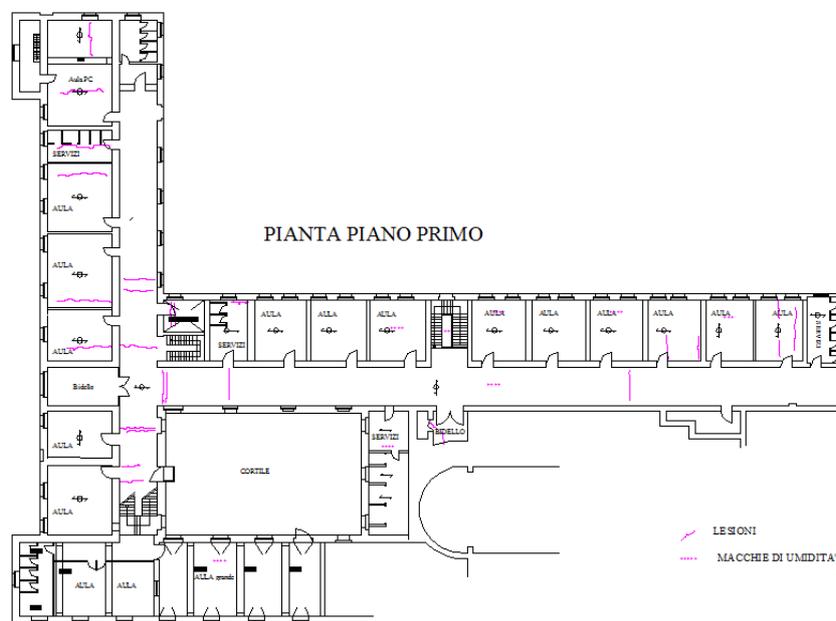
Rilievo quadro fessurativo primo piano (Allegato 6)
